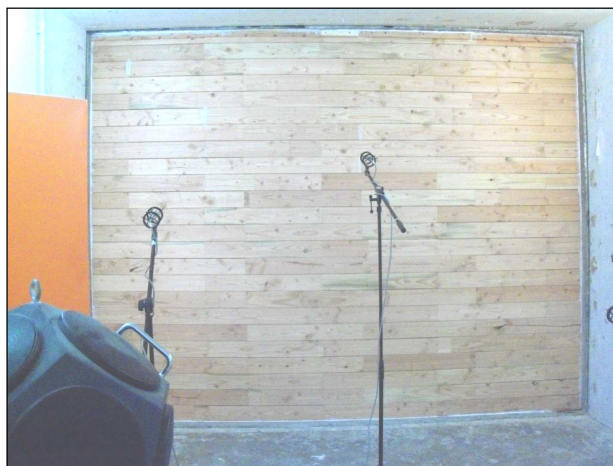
Cerramiento a base de ECO LADRILLO MASENA, terminado y listo para ensayo
